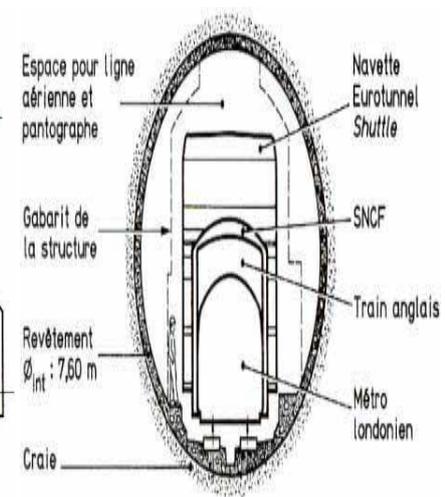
Section transversale du tunnel sous la Manche.
